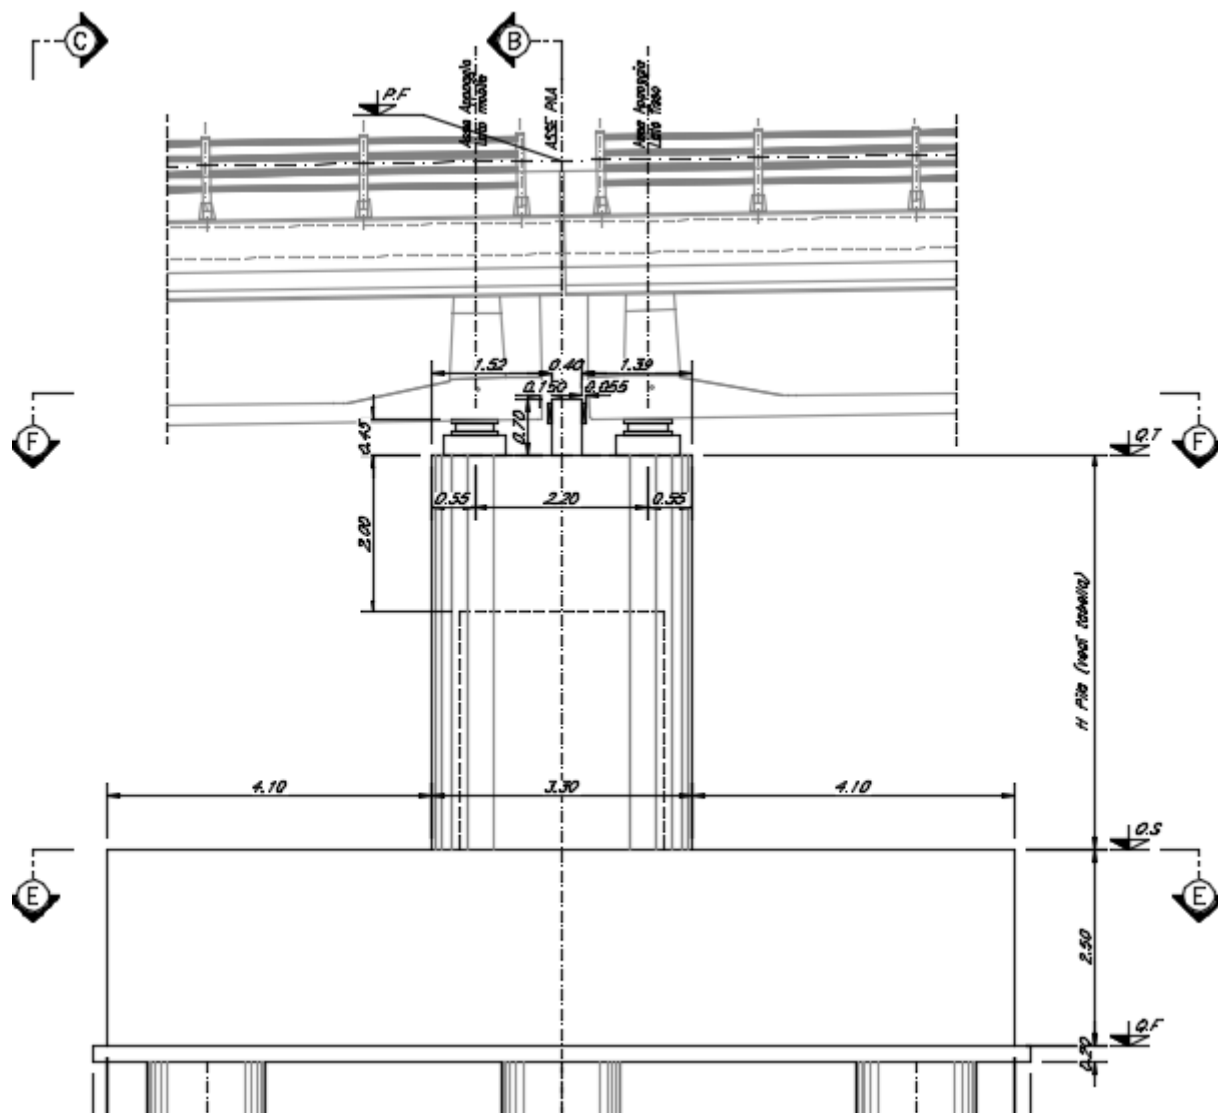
Pila scatolare doppio binario – prospetto longitudinale
